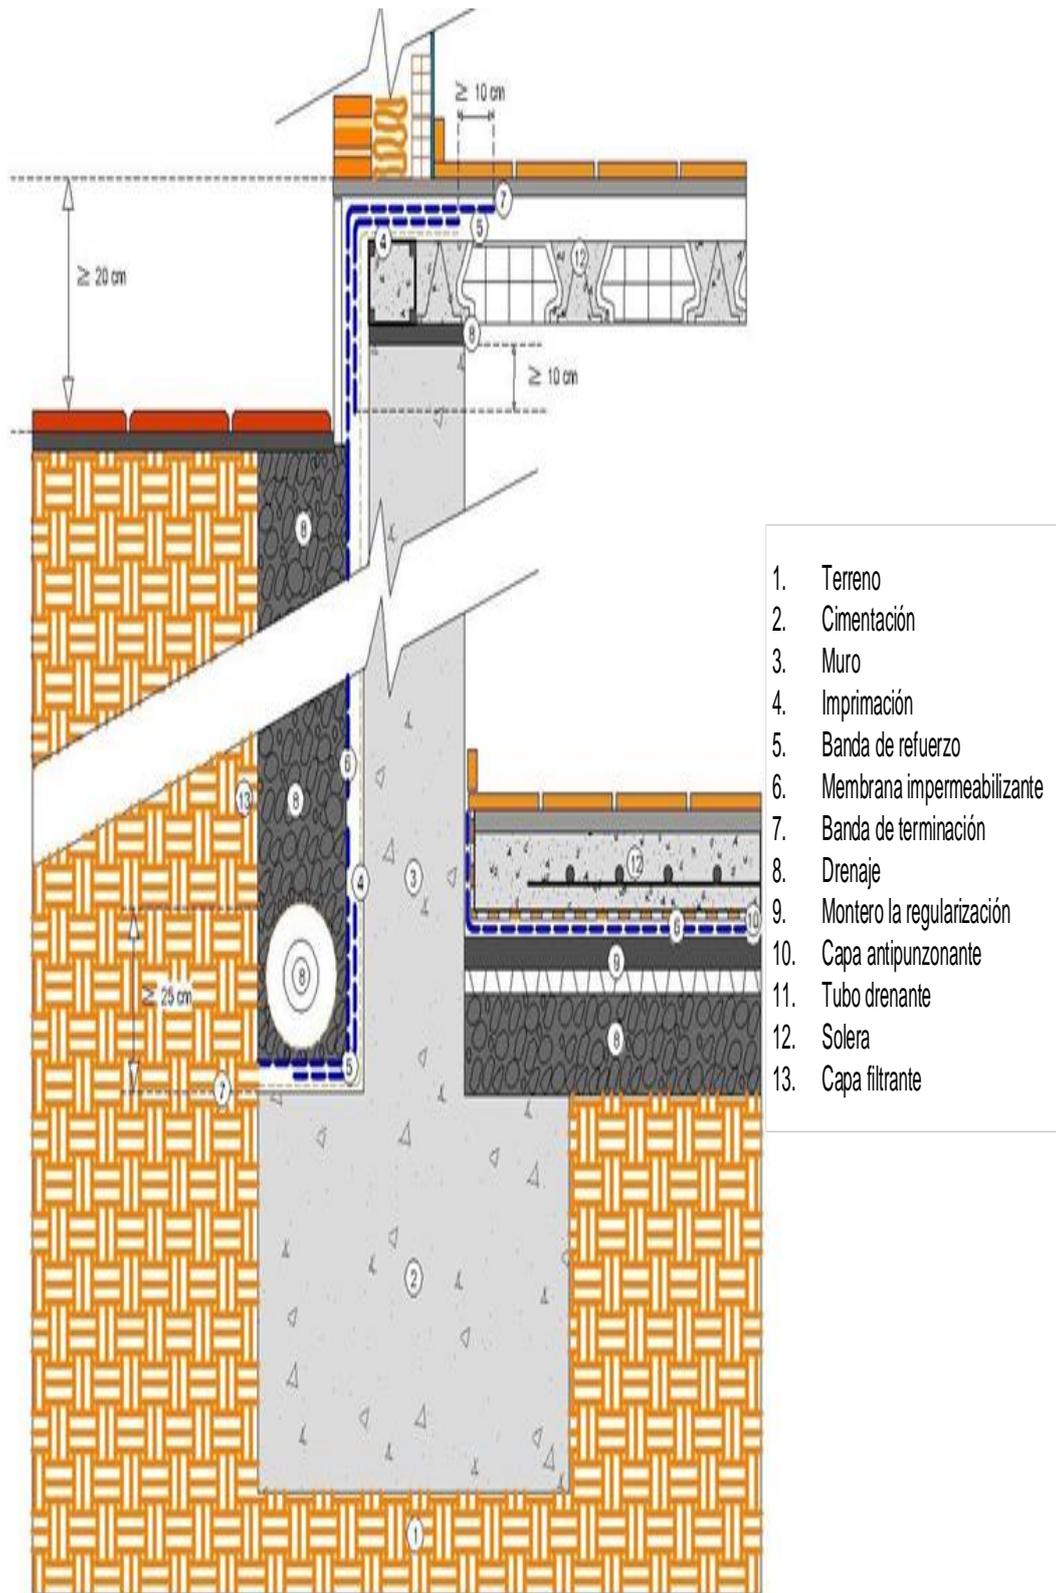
Impermeabilización de cimientos corridos drenaje de encachado
